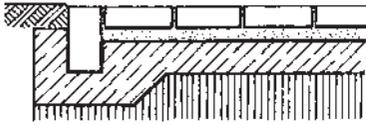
A haces con la superficie pavimentada. La pendiente va con el borde del pavimento.
